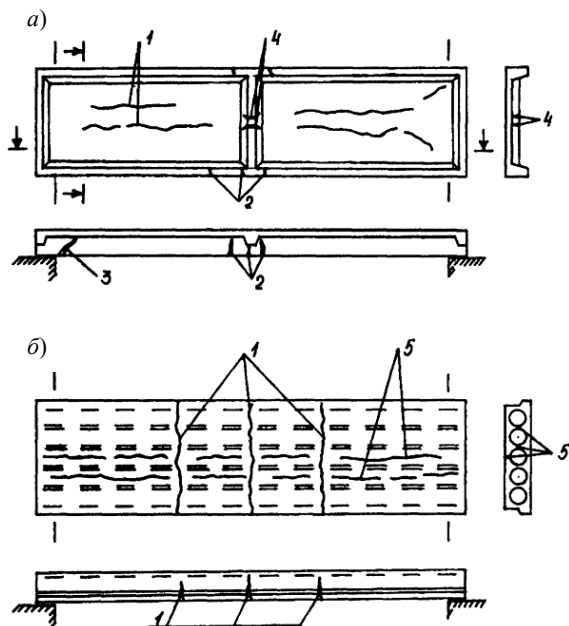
Трещины в сборных панелях перекрытий:
